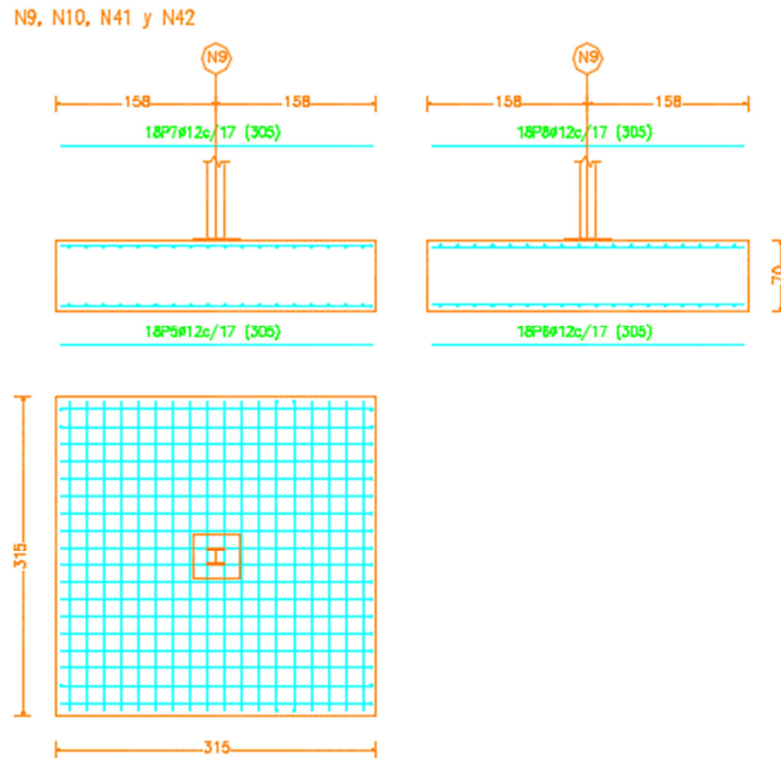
Detalle de la cimentación del primer pórtico intermedio
